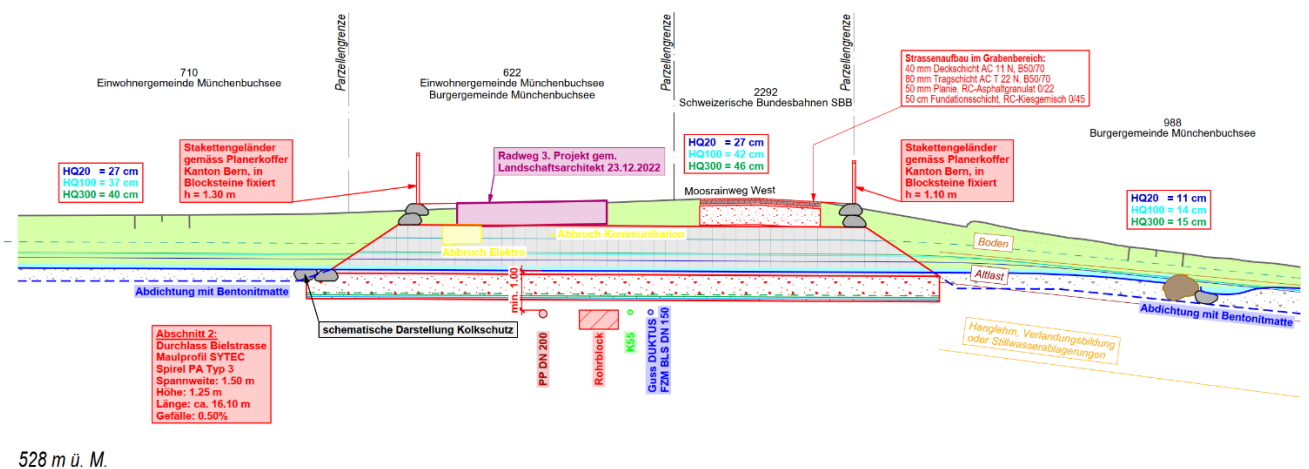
Ausschnitt Normalprofil Stand Wasserbauplan, 26.07.2024
